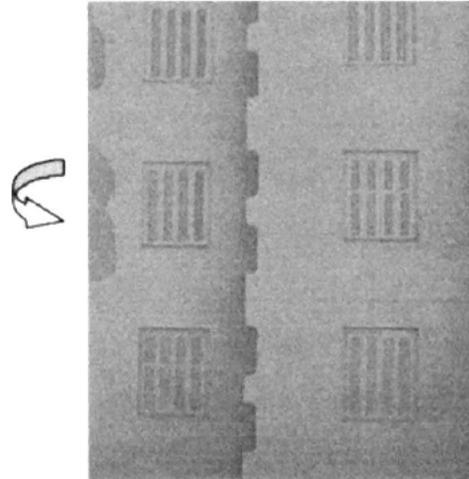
Décollement de l'enduit tyrolien au niveau de la façade
